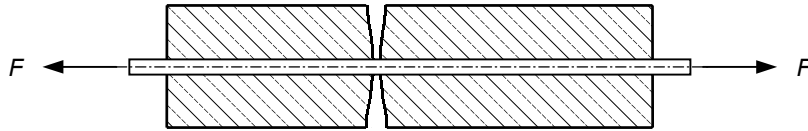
Erstrissbildung an einem Stahlbetonzugstab
